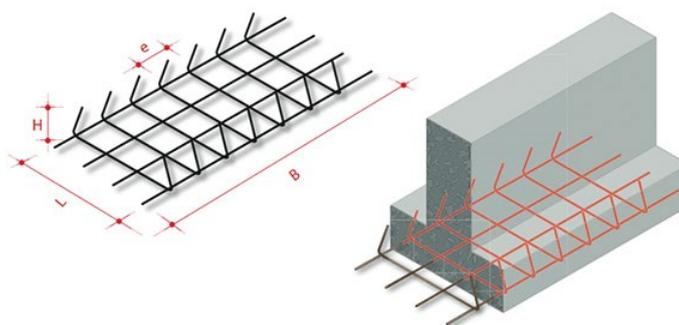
Schéma du ferrailage de la semelle filante ¹²²
